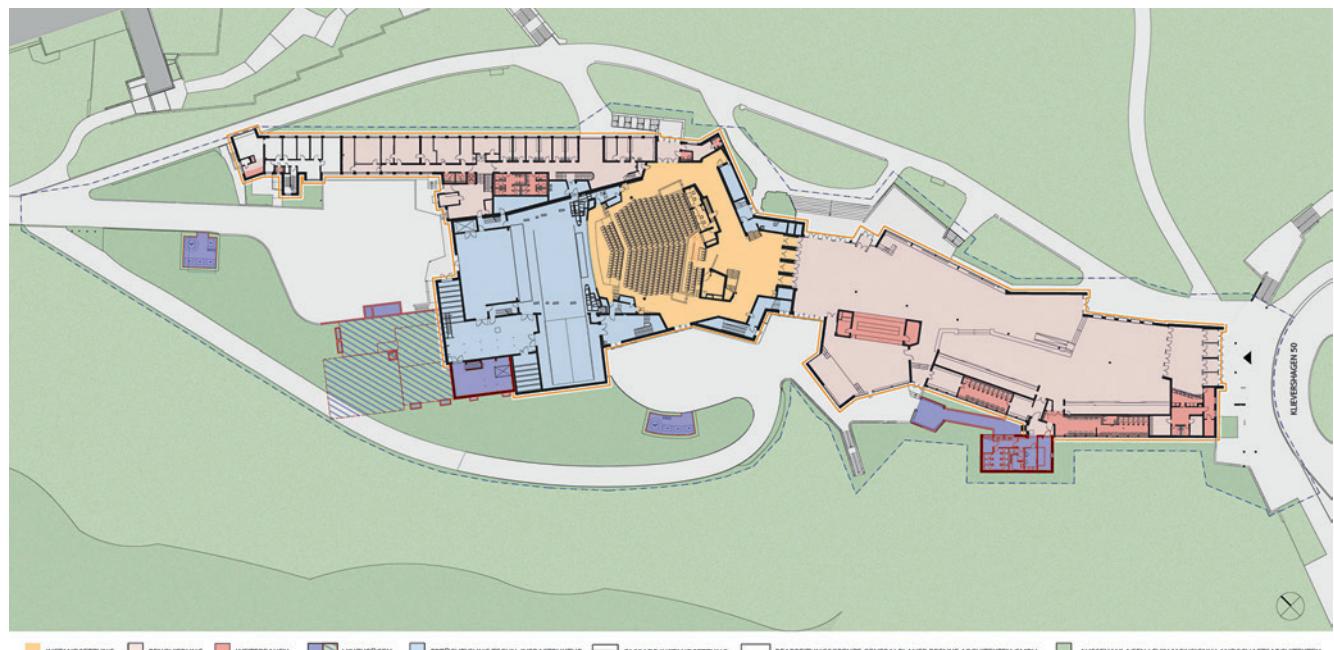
Im Grundriss des Erdgeschosses sind die verschiedenen Baumaßnahmen farbig eingetragen – vom Instandsetzen, Renovieren und Ertüchtigen bis zum Weiterbauen und Hinzufügen. (© Brenne Architekten)
